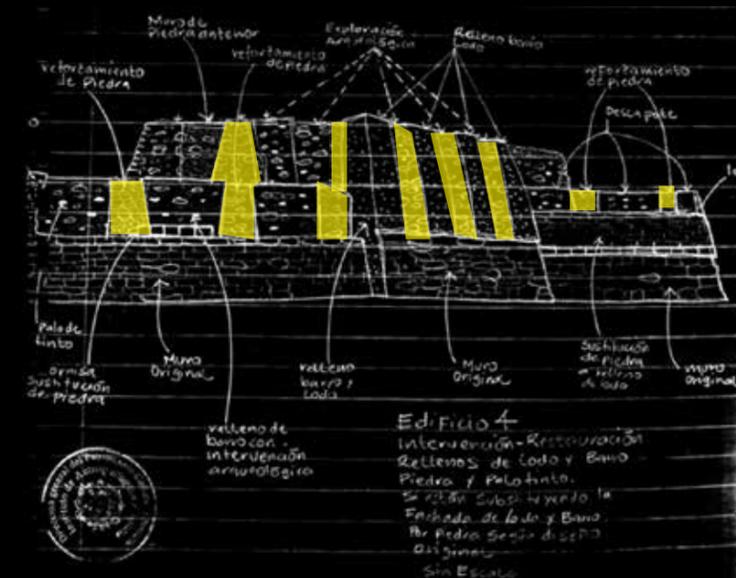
Dibujo Edificio 4 Fachada sur Transición de fachada de lodo reciclado a fachadas de piedra. Descapote e integración de fachada de piedra en primer en segundo cuerpo. Dibujo: GAMH 2002
